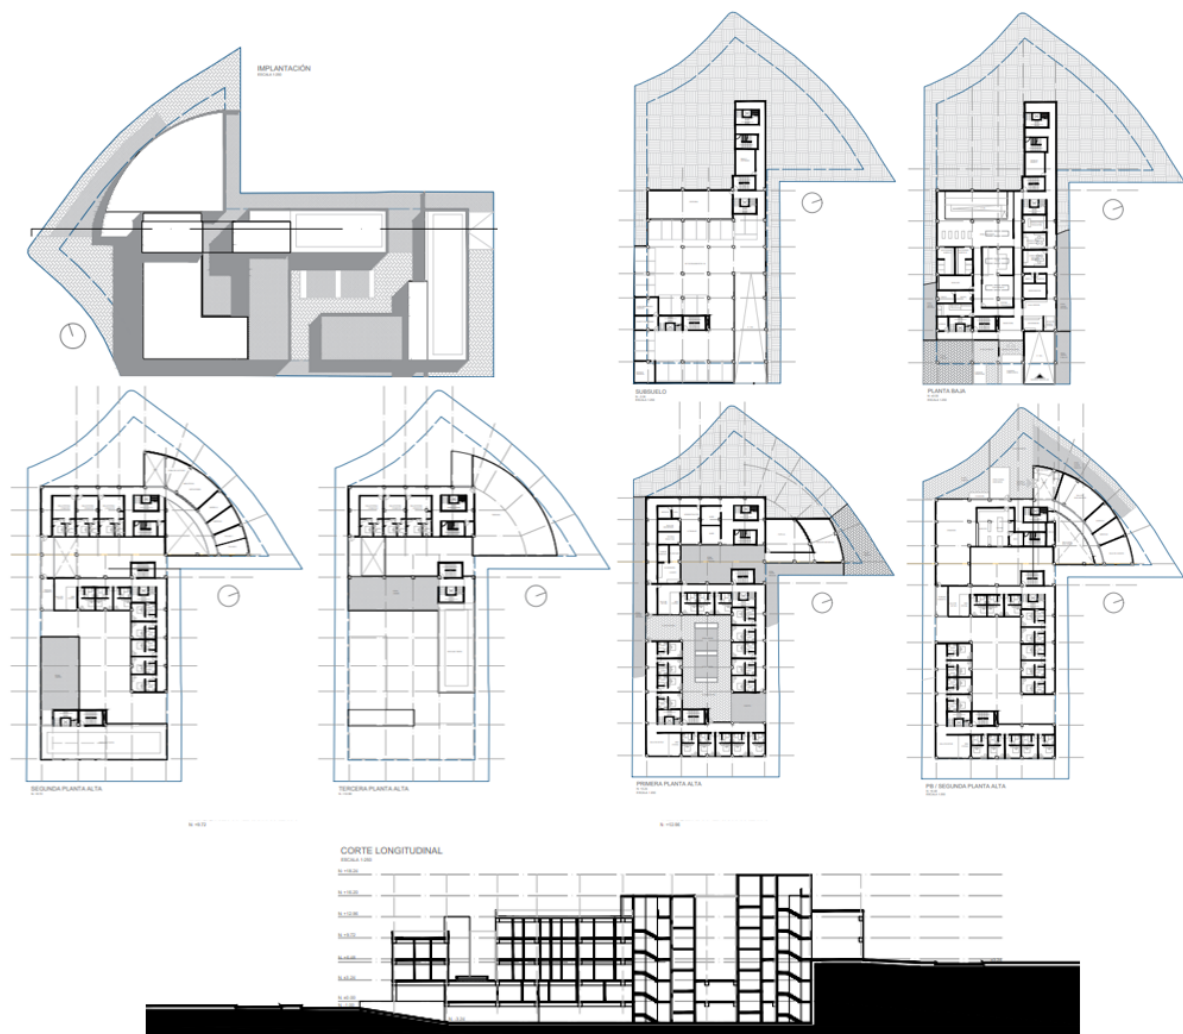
Planimetría primer anteproyecto. Elaboración personal.
